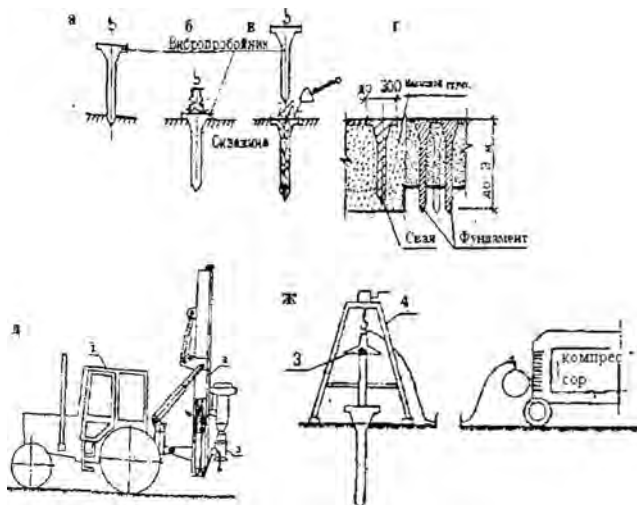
Принципиальная технологическая схема и состав оборудования для устройства набивных и забивных микросвай с использованием вибропробойников: а – установка штампа или забивной микросваи на точку погружения; б – погружение штампа или сваи; в – извлечение штампа и бетонирование скважины; г – готовая набивная микросвая или фундамент; д – вариант виброустановки навешенной на базовую машину трактор «Беларус»; ж – то же, на переносной треноге; 1 – базовая машина; 2 – навесное оборудование с вибропогружателем; 3 – гидropневмопробойник; 4 – переносная тренога
